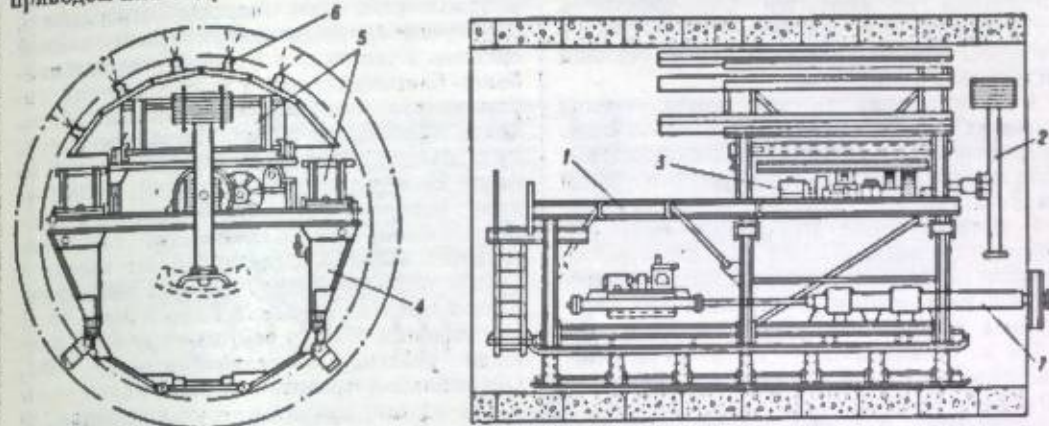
Блокоукладчик для обделки diam. 5,1 м: 1 — рама; 2 — рычаг (рука); 3 — механизм привода; 4 — порталная рама; 5 — выдвижные площадки; 6 — выдвижные балки; 7 — механизм передвижки блокоукладчика.
